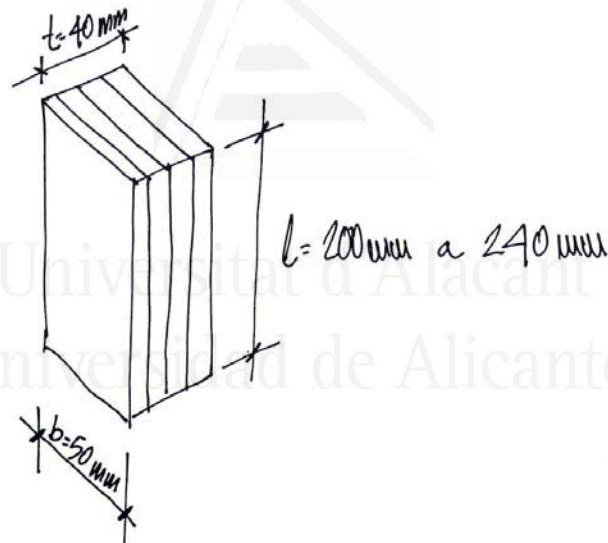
Dimensiones de la probeta con espesor de 10 mm.
